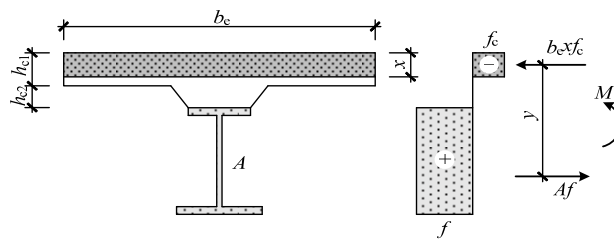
塑性中和轴在混凝土翼板内时的组合梁截面及应力图形
